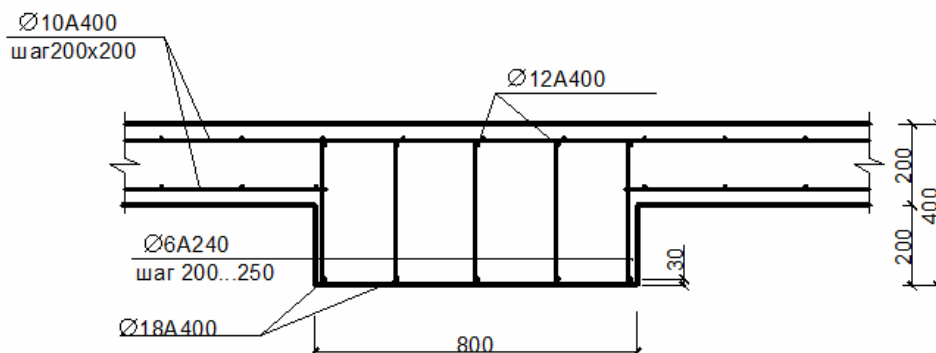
Сечение балки монолитного перекрытия и ее армирование
